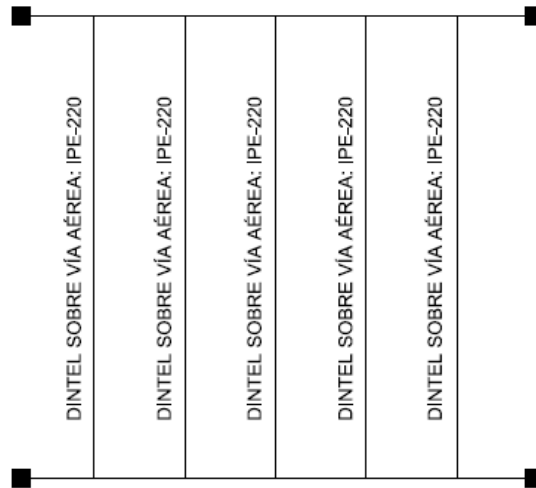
Pórtico de la estructura portante de la cámara de canales (planta).
